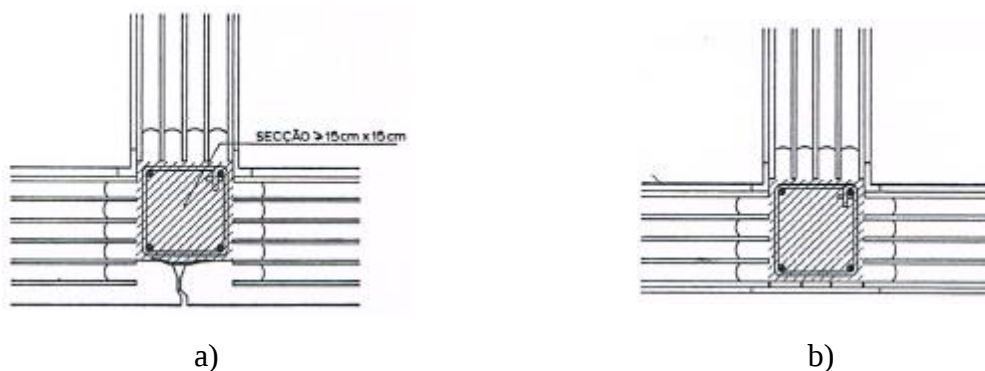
Pormenor de montante na convergência de: a) Dois painéis de fachada com painel interior; b) Três painéis interiores. (LNEC, 1968).
